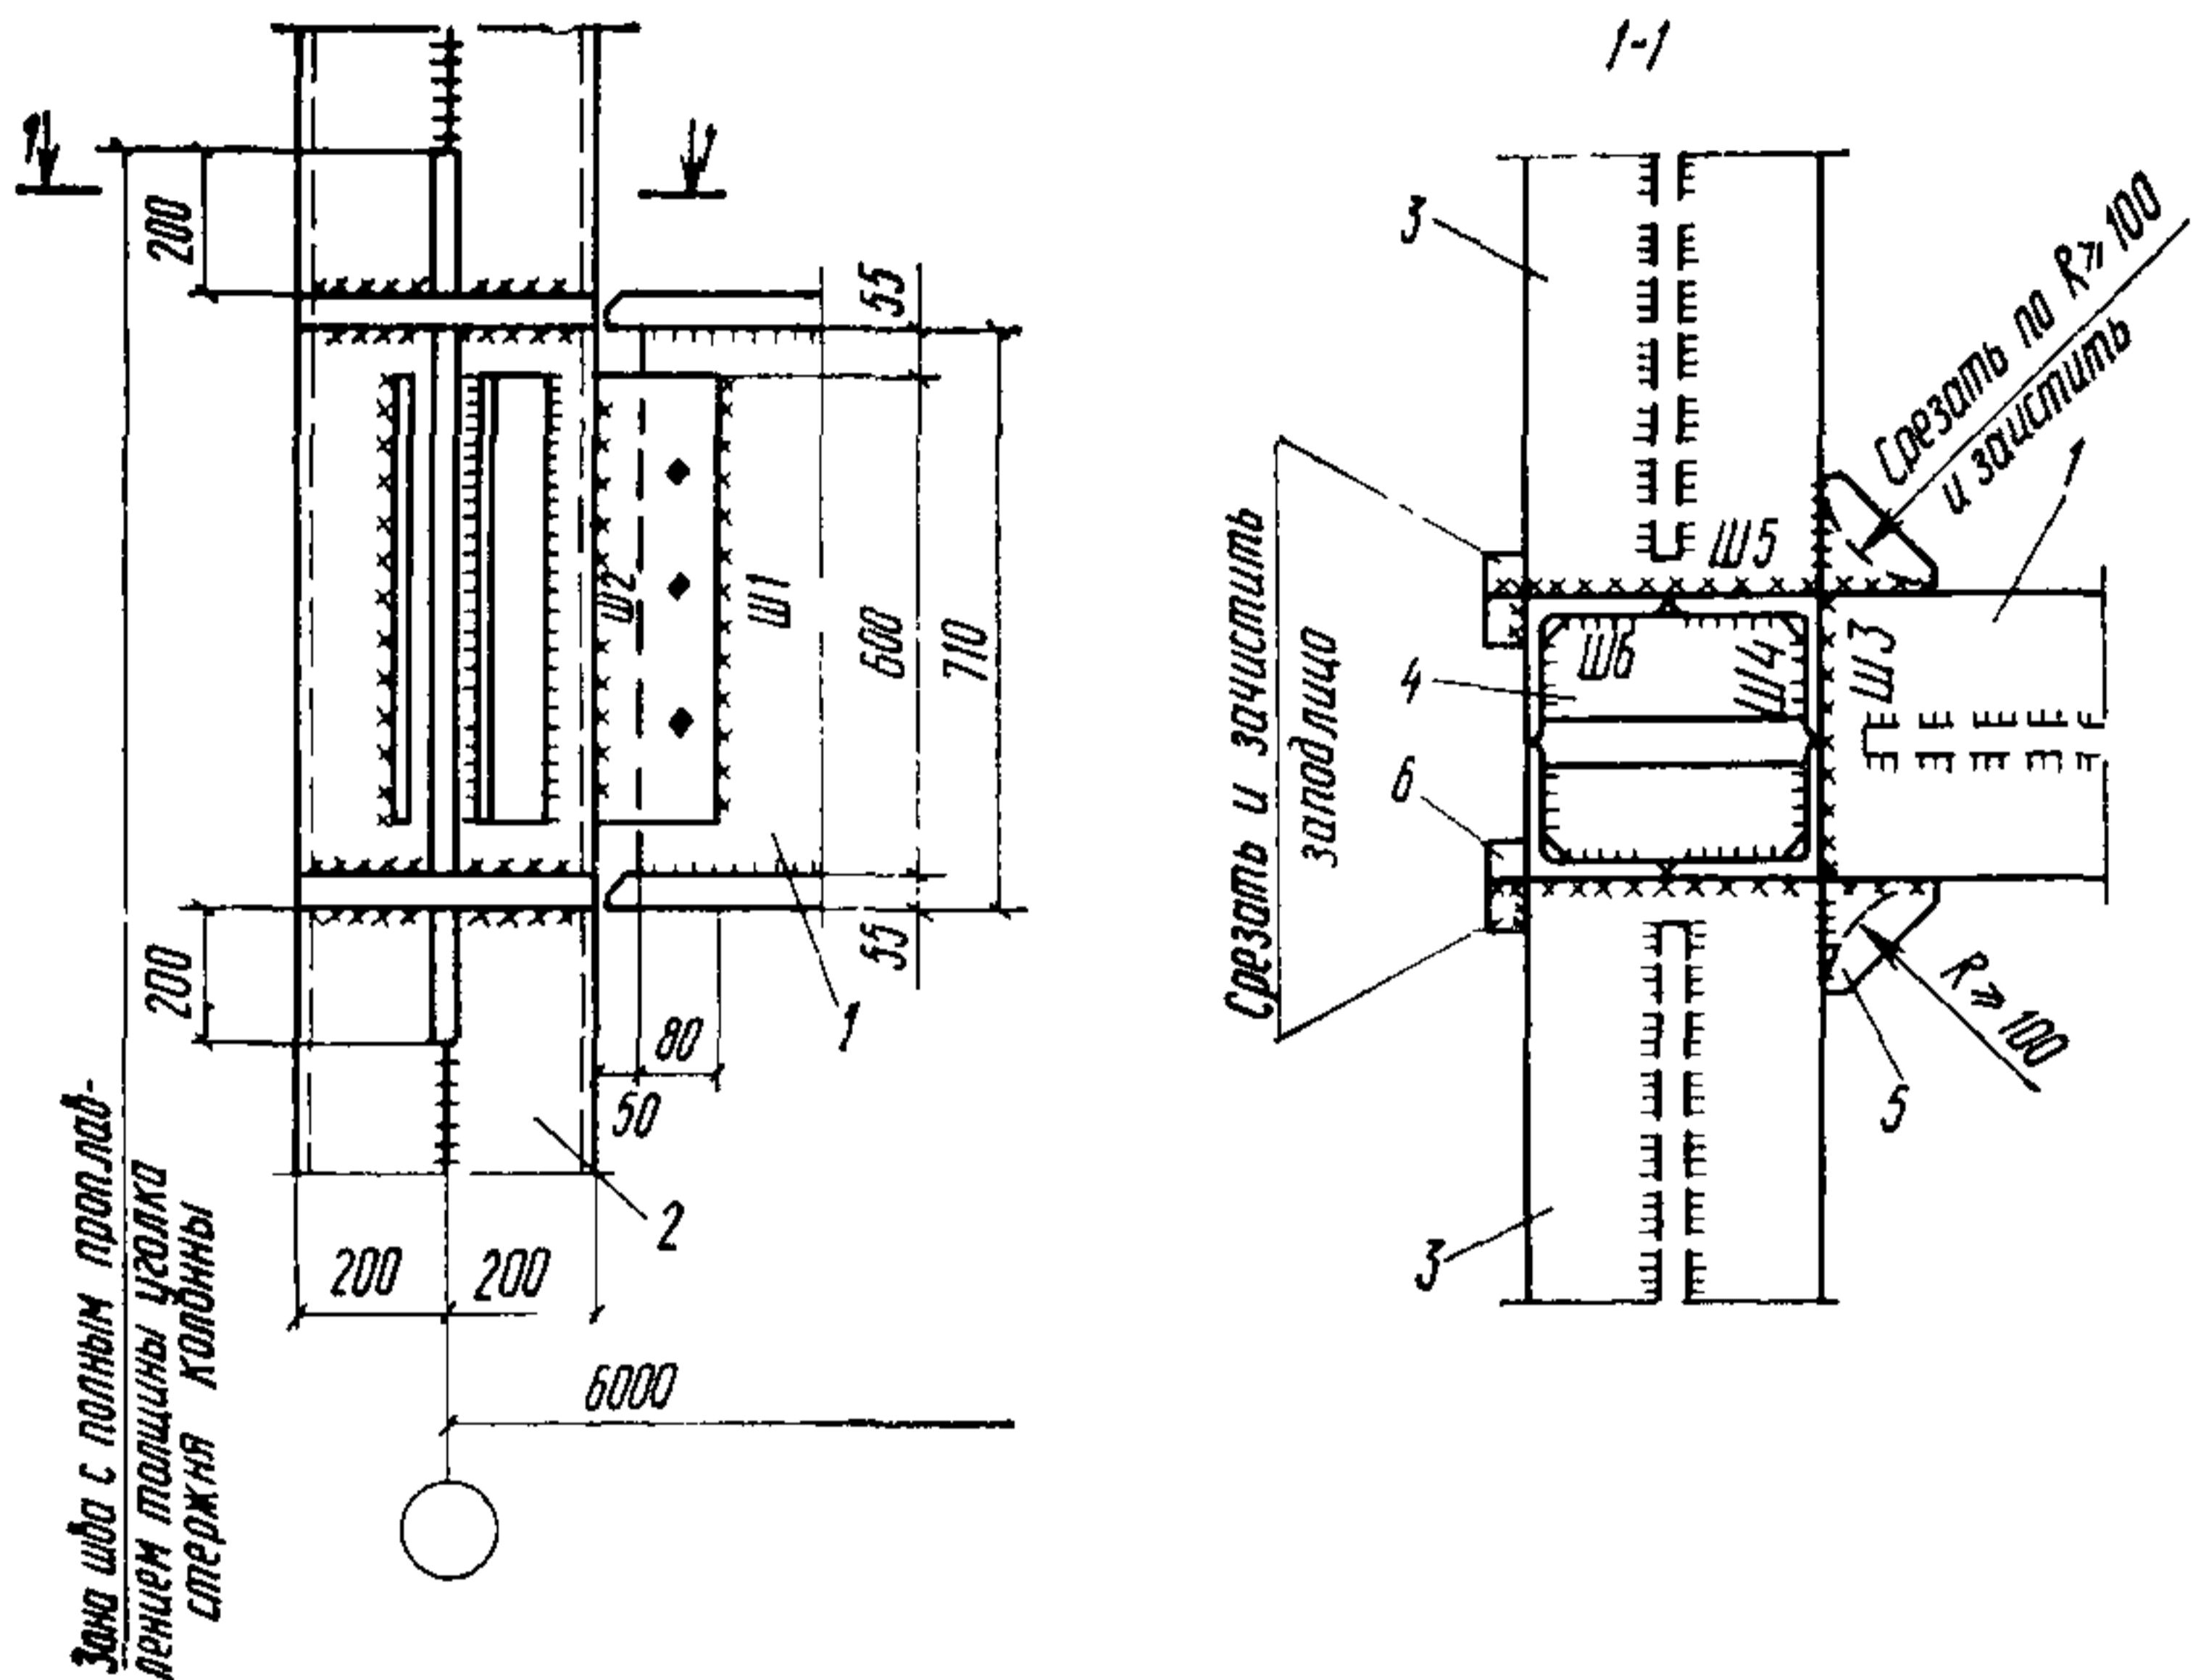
Узел сопряжения ригеля с колонной многоэтажного здания
